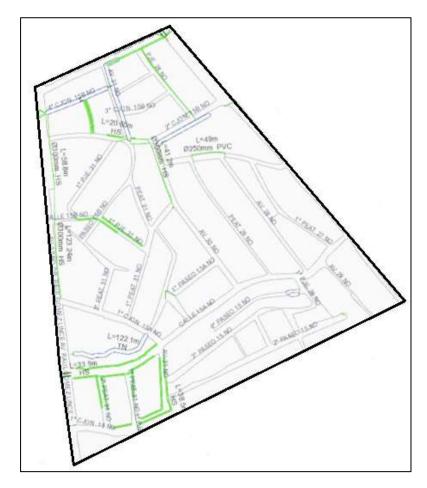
Ausencia de alcantarillado pluvial en Urbanor. Fuente: INTERAGUA.
